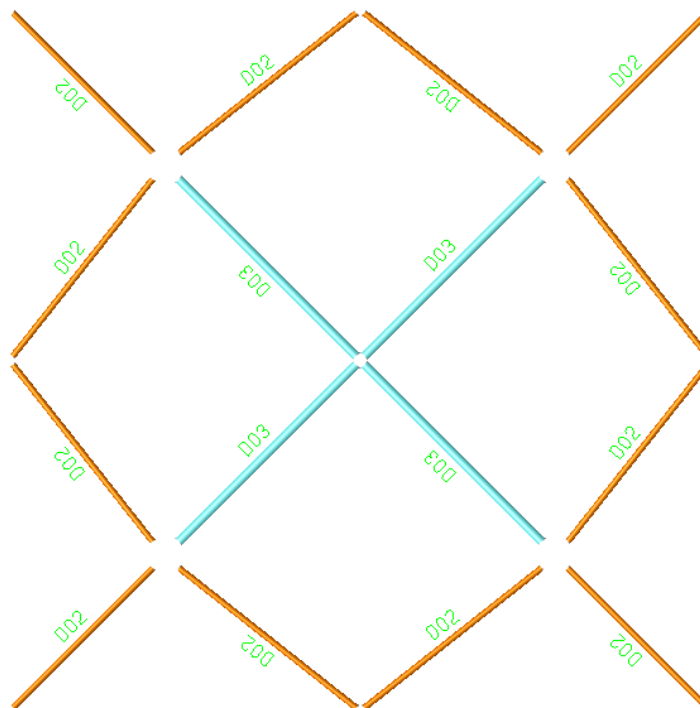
Elementi orizzontali a sezione tubolare - impalcato Quota 32 m (copertura)
